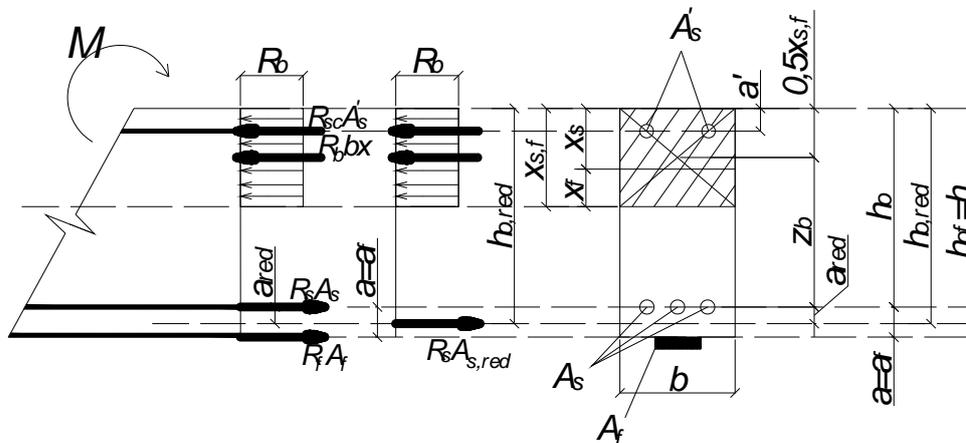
Расчетная схема и эпюры напряжений в нормальном к продольной оси сечения изгибаемого элемента, усиленного внешней композитной арматурой применительно к универсальному методу расчета.
